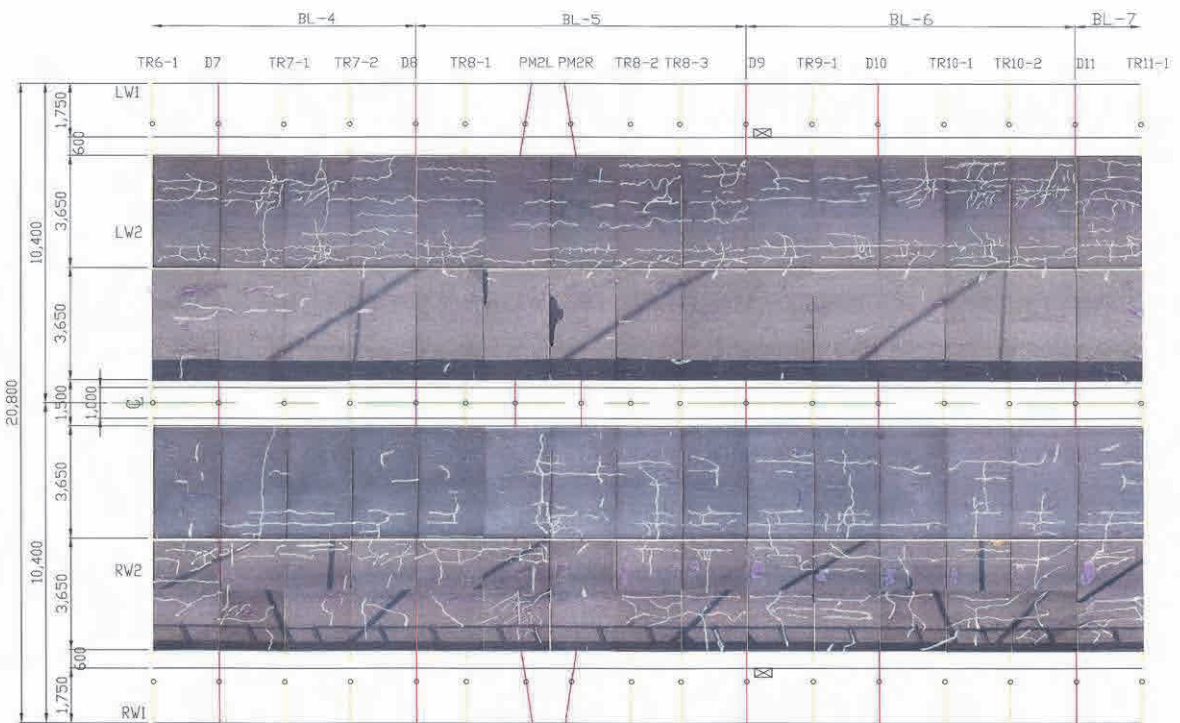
ひび割れ図 (BL4 - BL6)
